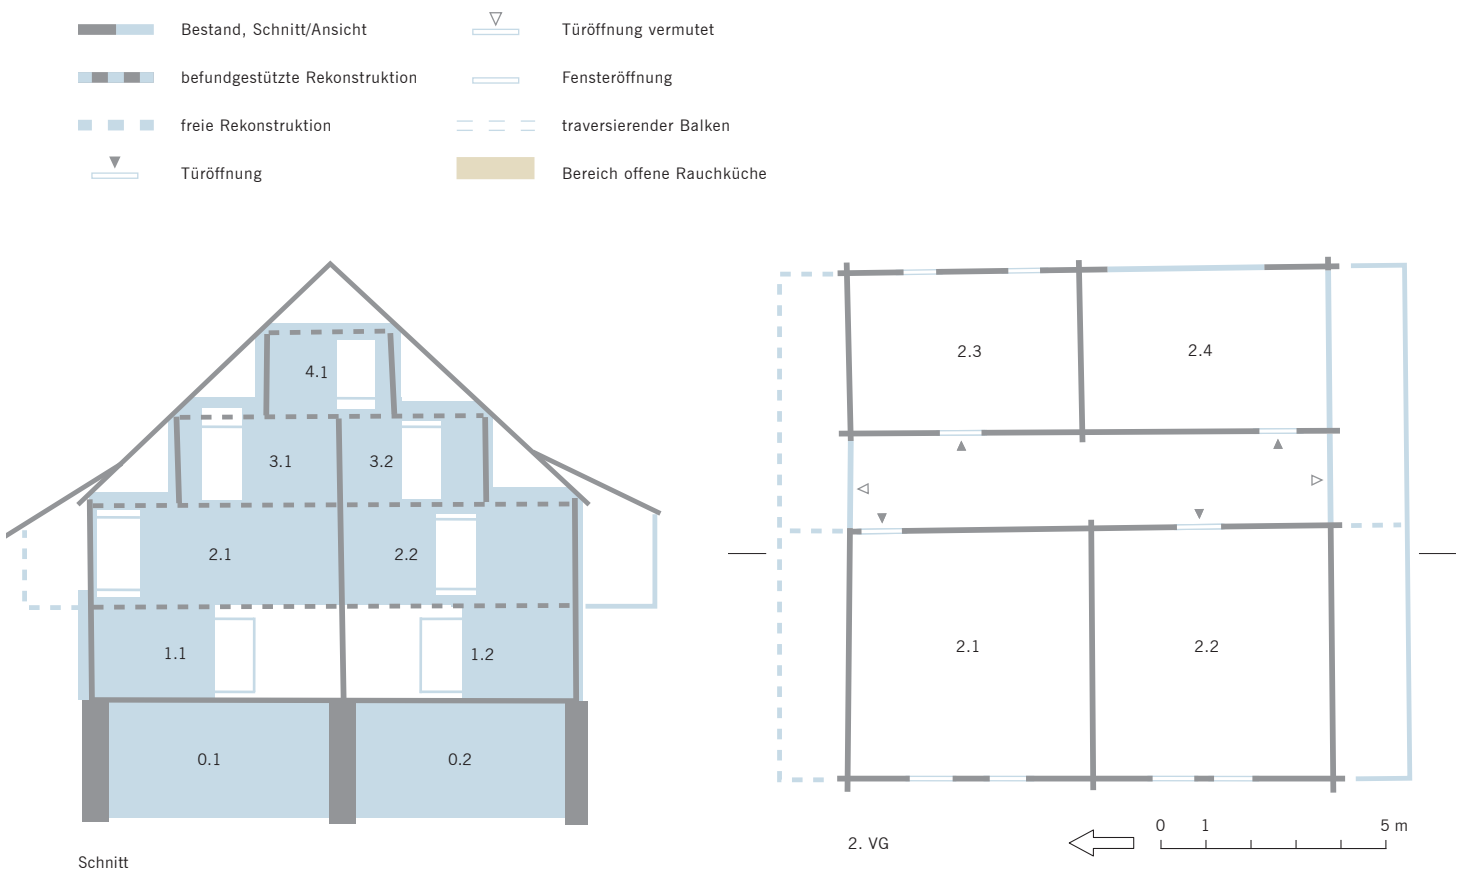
Haus Artherstrasse 125/127 in Oberwil bei Zug, rekonstruierter Schnitt und Grundriss des Gründungsbaus.
